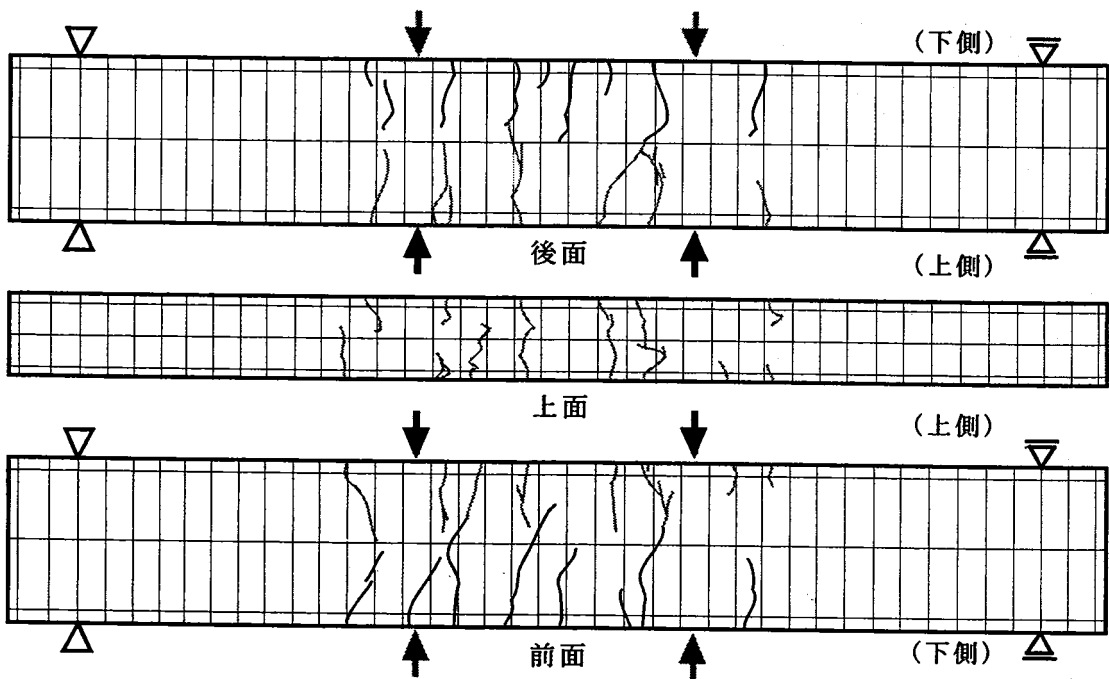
b) ひび割れ性状 [BS-2 ; R = 1/800rad.]
